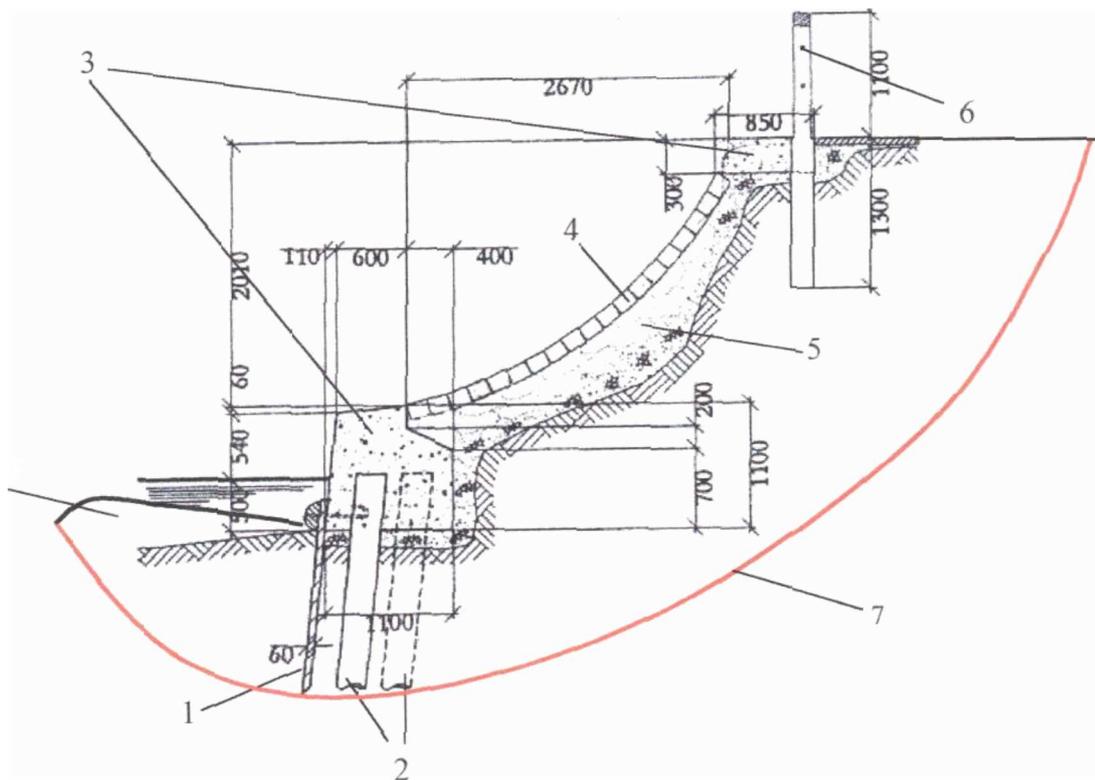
Конструкция набережной Петровского стадиона: 1 – деревянный шпунт; 2 – деревянные сваи (2 ряда); 3 – бетонная (нижняя) и гранитная (верхняя) части банкета; 4 – диабазовое мощение на цементном растворе; 5 – каменная наброска под диабазовое мощение; 6 – набережная и ее ограждение; 7 – поверхность скольжения в откосе набережной; 8 – вал выпирания.
